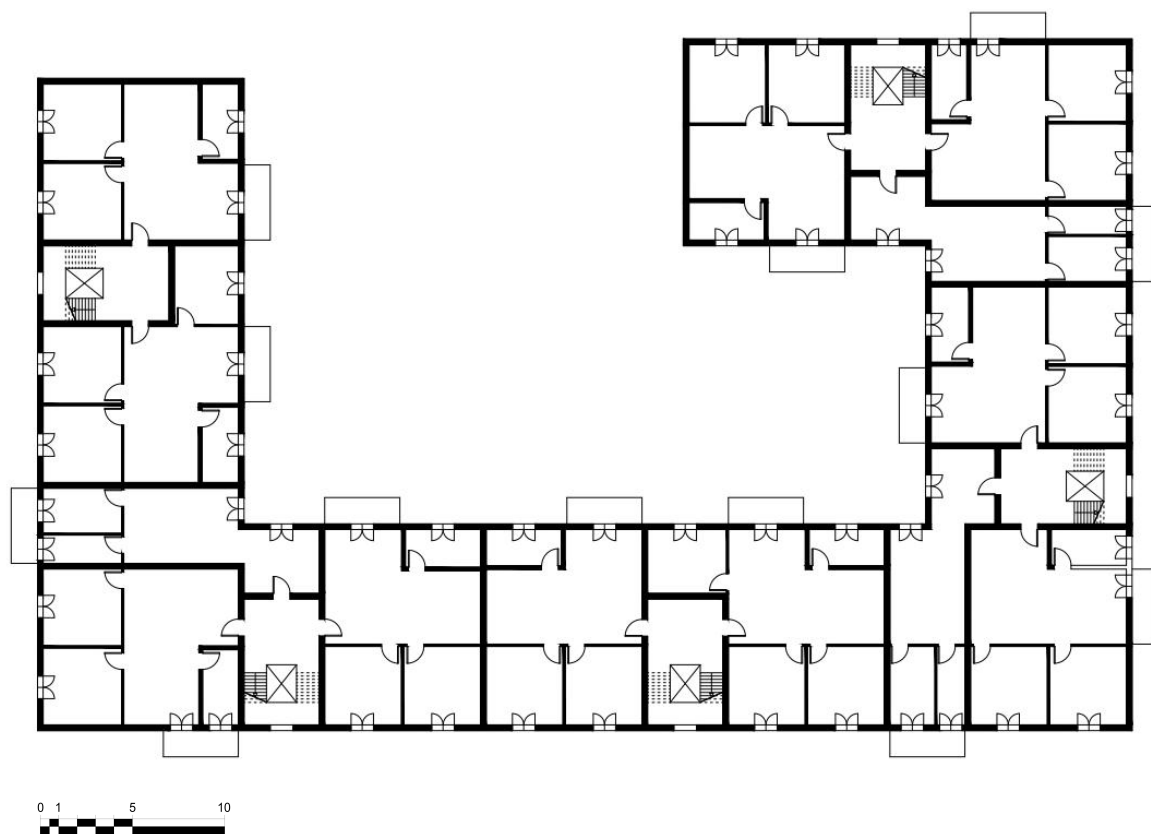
Pianta piano tipo Edificio 1 - elaborazione dell'autore
